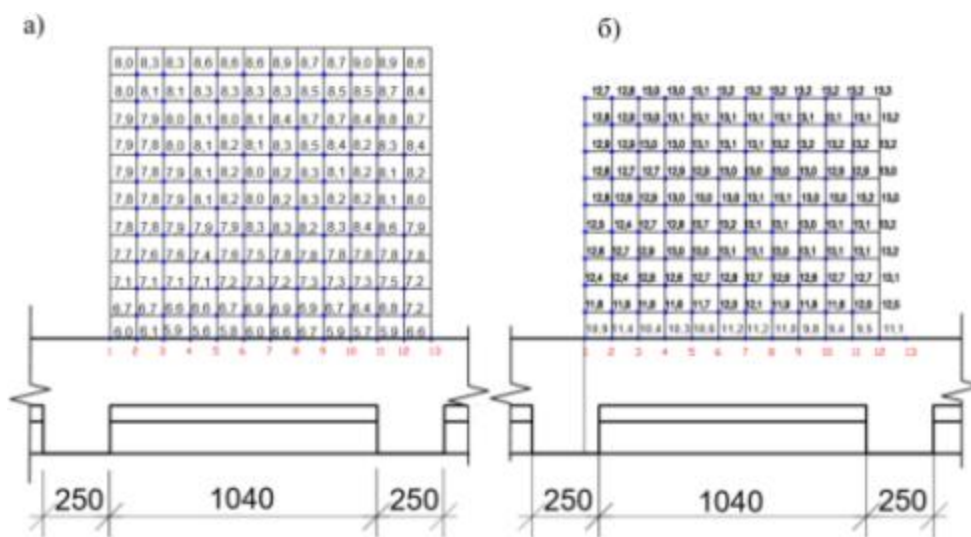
Розподіл температури на розглянутих поверхнях плити перекриття (тип 3): а) верхня грань плити перекриття (підлога); б) нижня грань плити перекриття (стеля)
